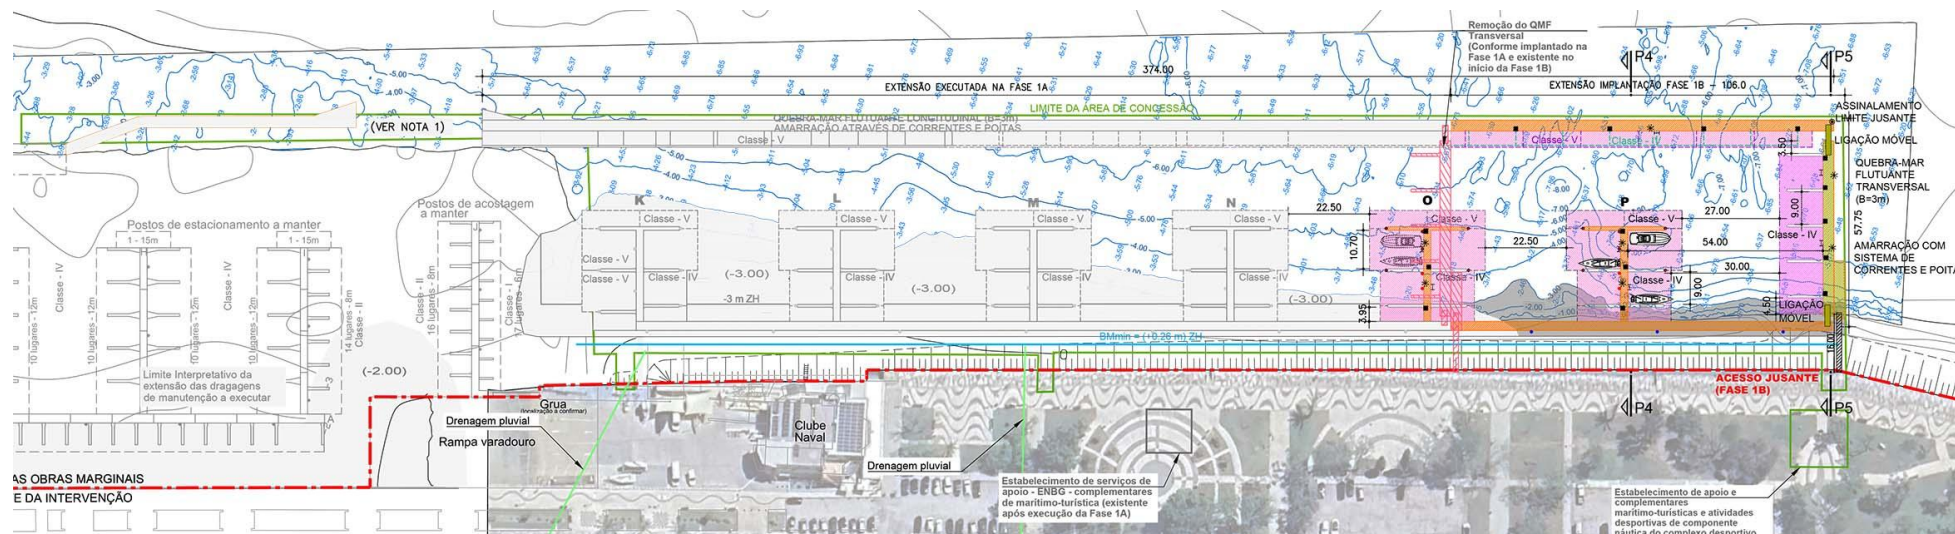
Planta da Fase 1B da ampliação do PRG
